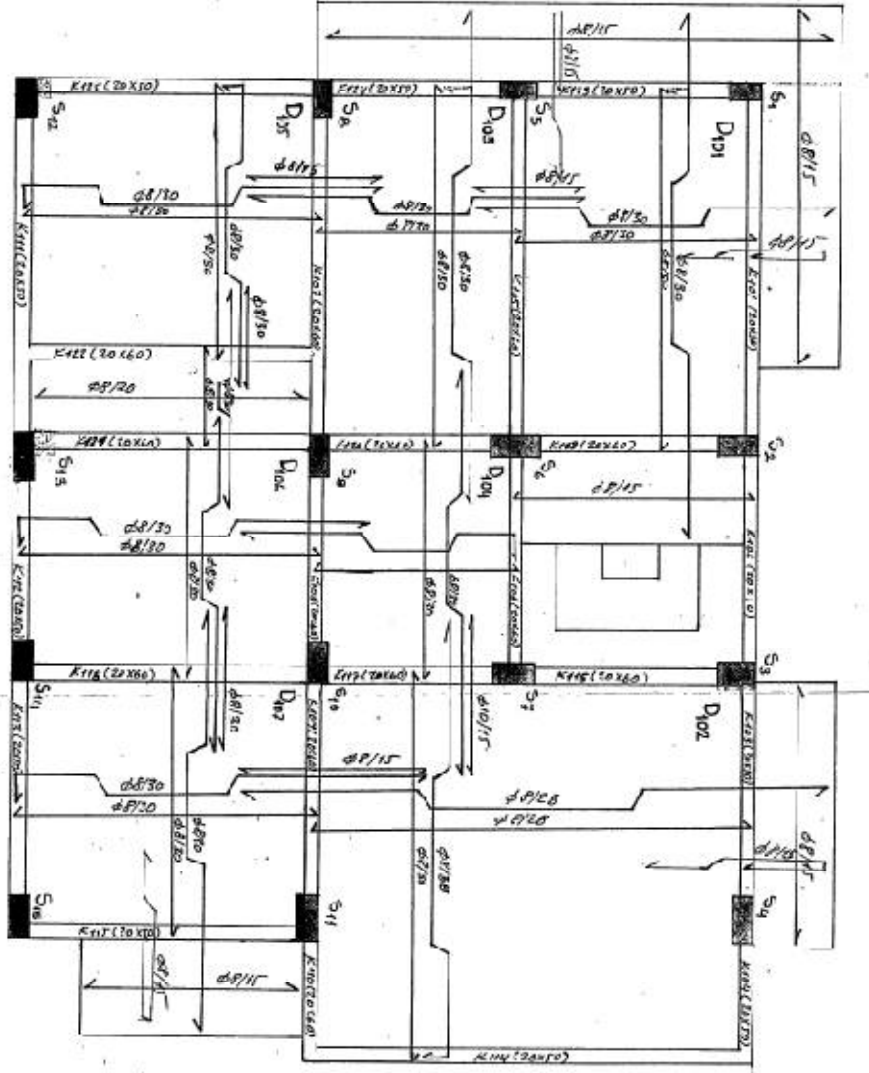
(2) Nolu bina mimari zemin kat planı
